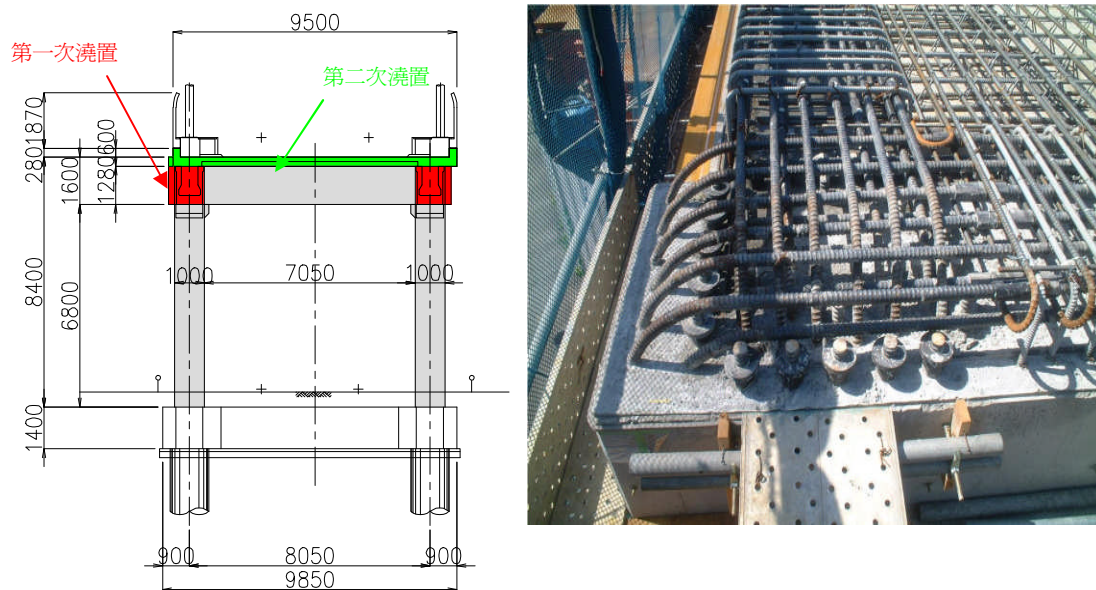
混凝土澆置示意圖及第一次澆置完成情形
